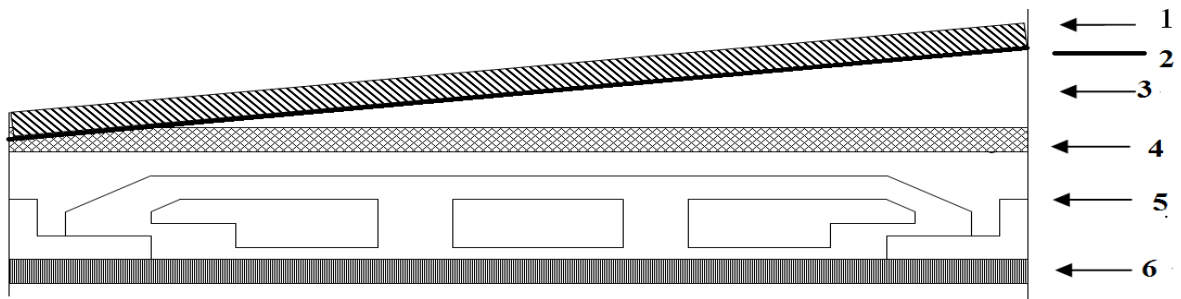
Descente de charge de Plancher terrasse inaccessible
